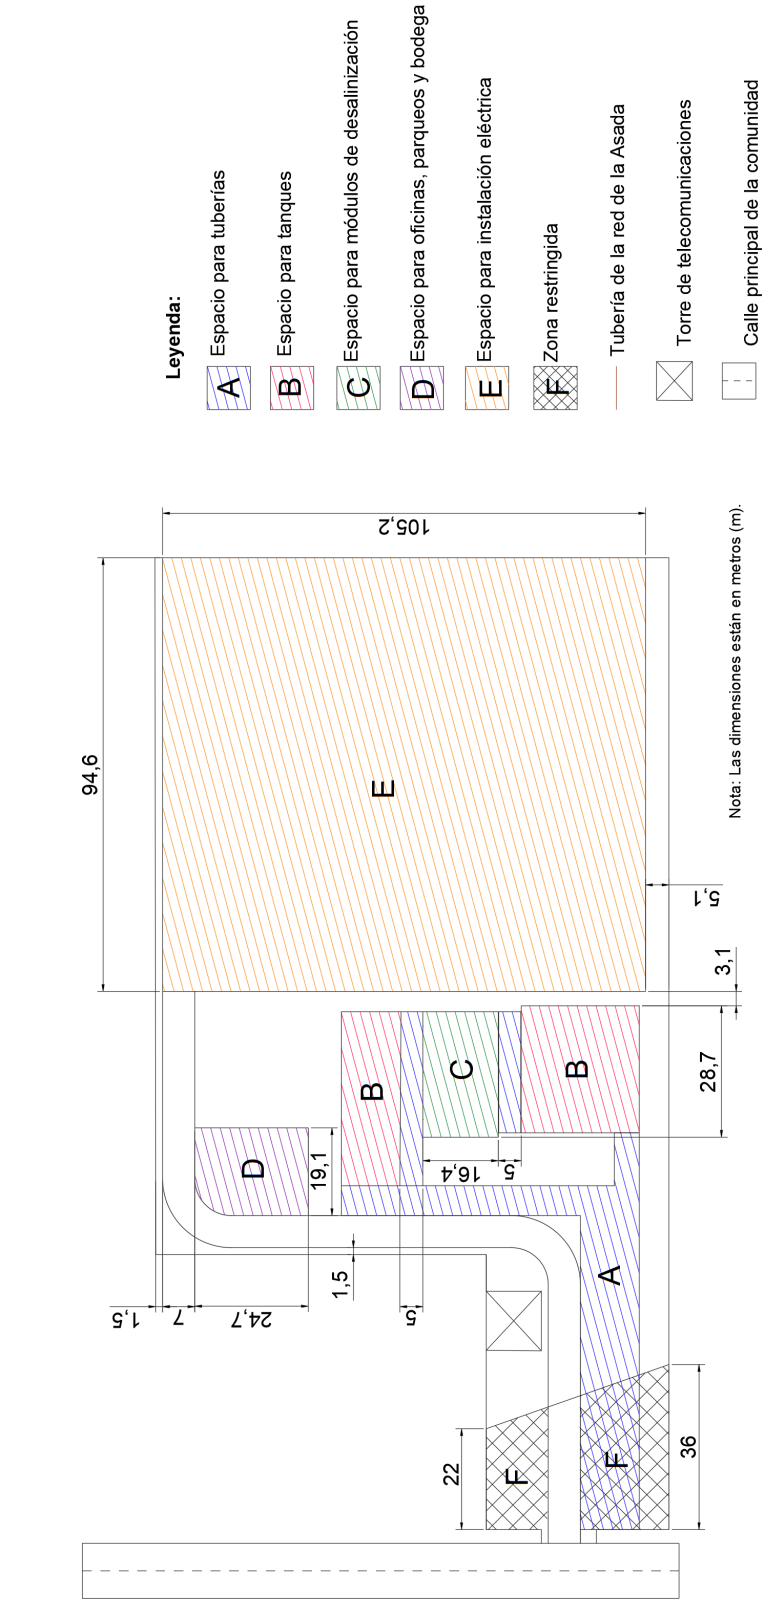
Distribución de planta preliminar del proyecto (Elaboración propia, 2018)
